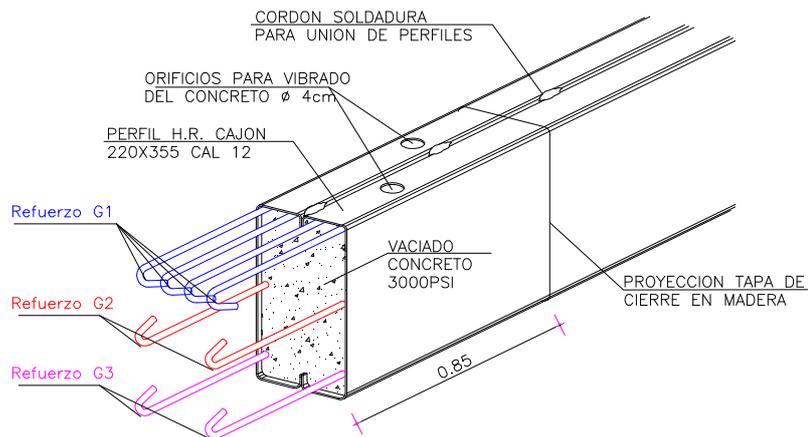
Armado de perflaría y conexión perfil-perfil
